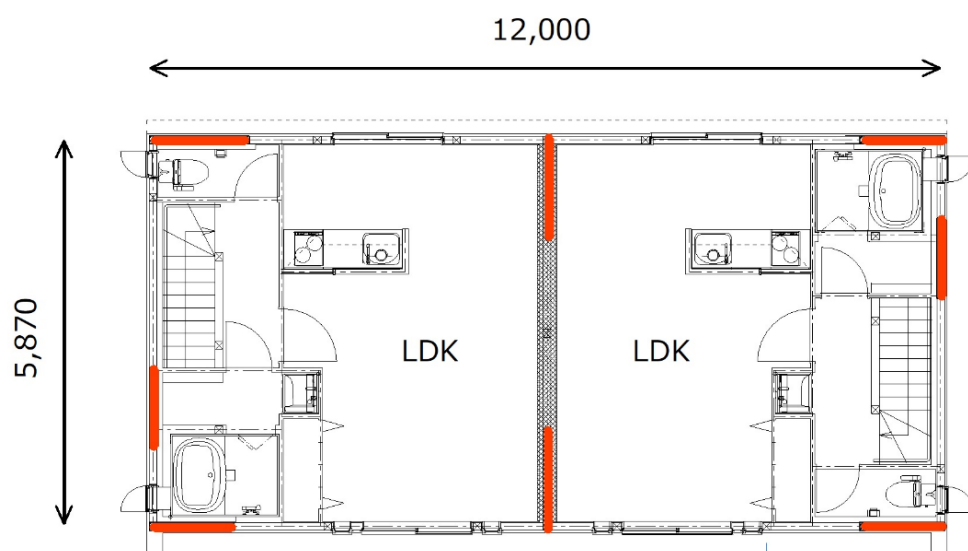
2 階平面図(赤線は CLT 耐力壁を示す)
